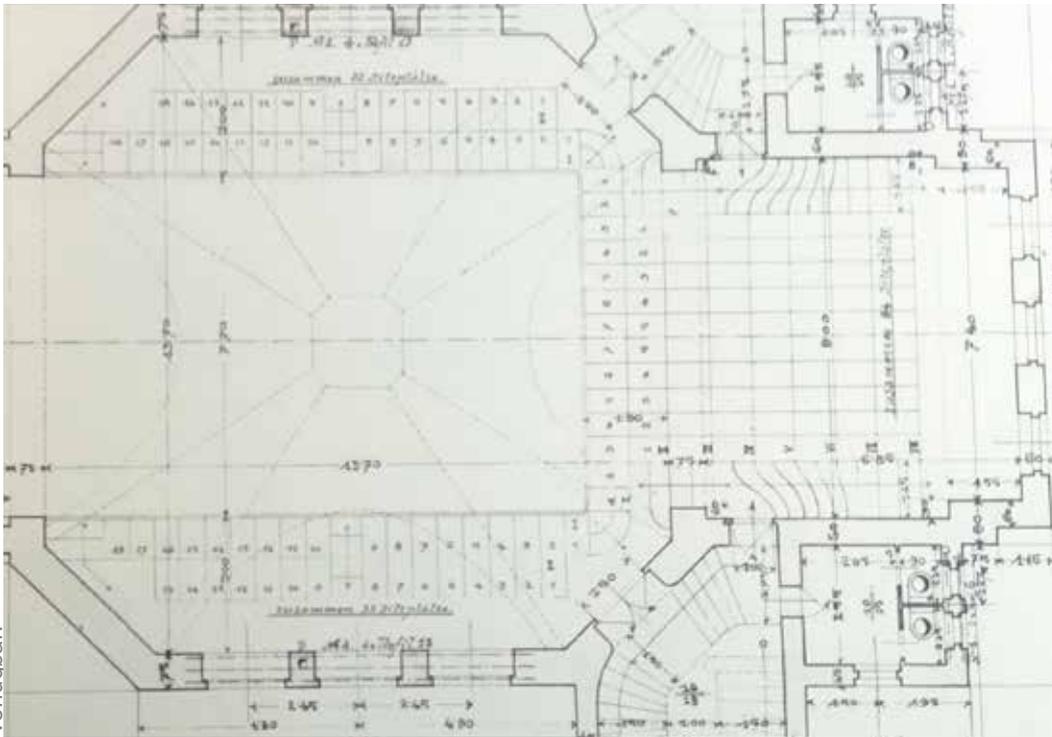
Ausschnitt des Originalgrundrisses OG, 1912
